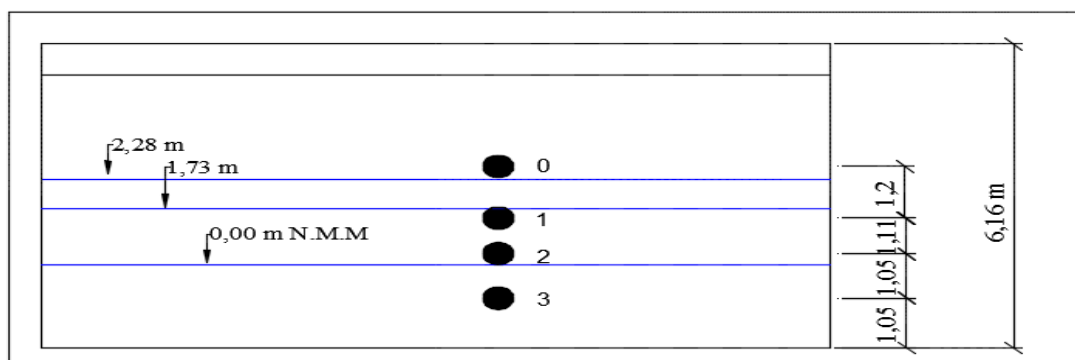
Instrumentación del muro [fuente Córdova et al. (2016)]
